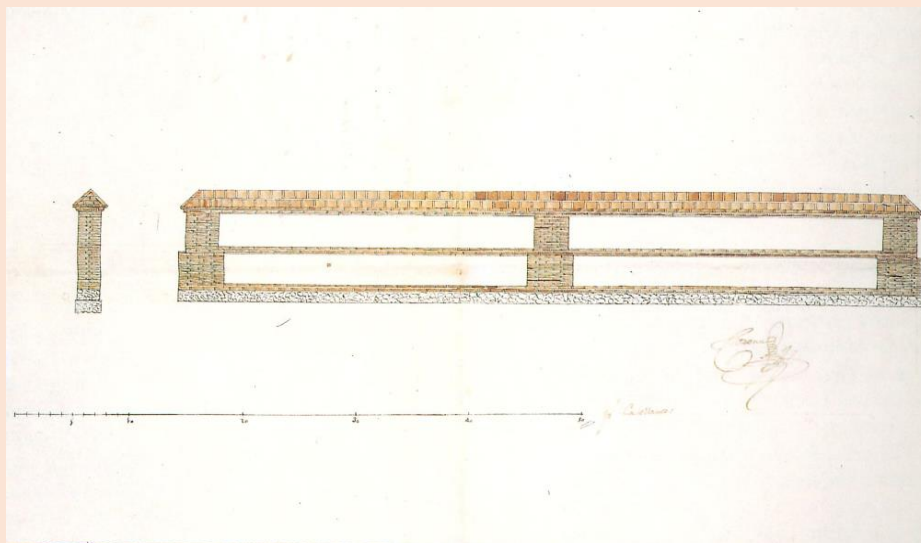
Alzado de las tapias de El Pardo. Siglo XVIII.
